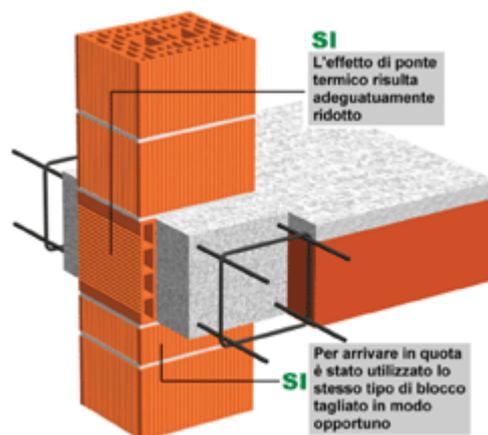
Corretta esecuzione del nodo muratura - solaio.
